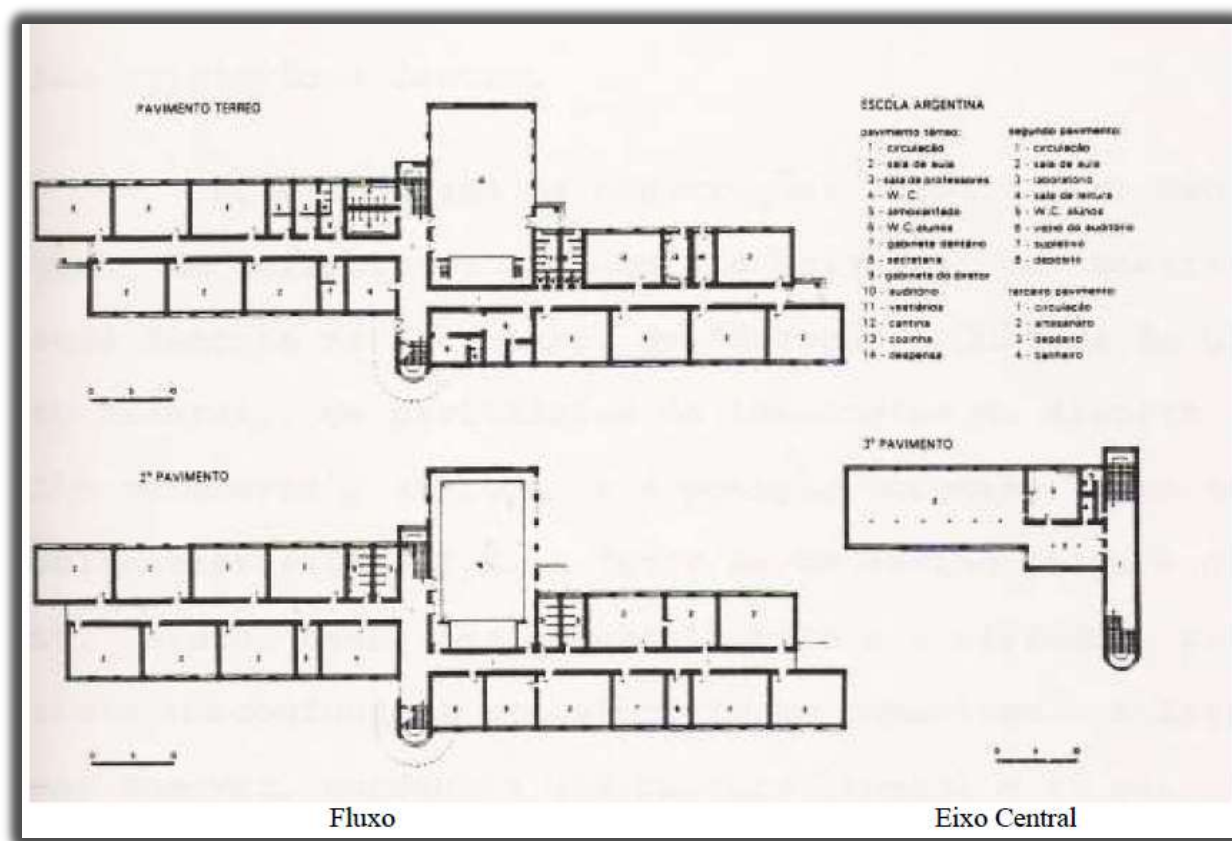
Escola Argentina/Planta baixa do térreo, 2º e 3º pavimento/Tipo *Platoon* (25 salas)
